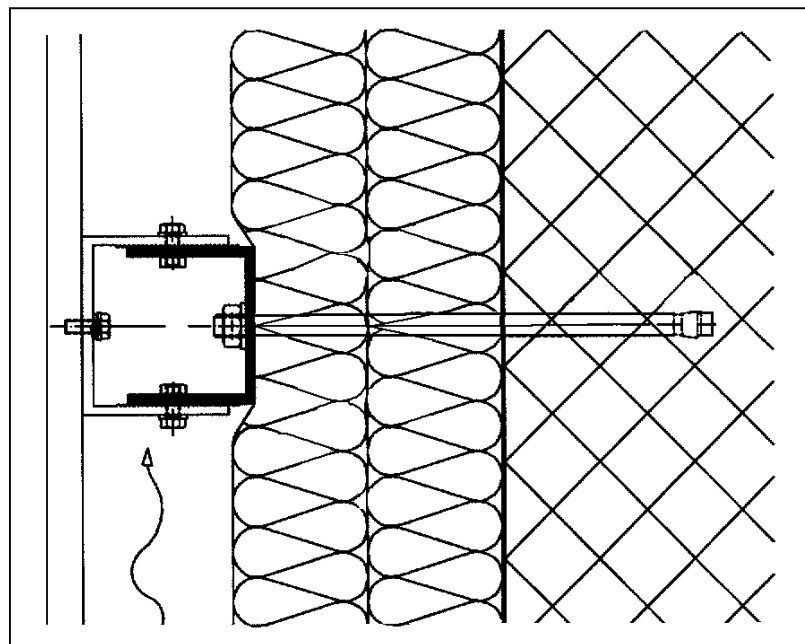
Horizontalschnitt vorgespannte Wärmedämmung
